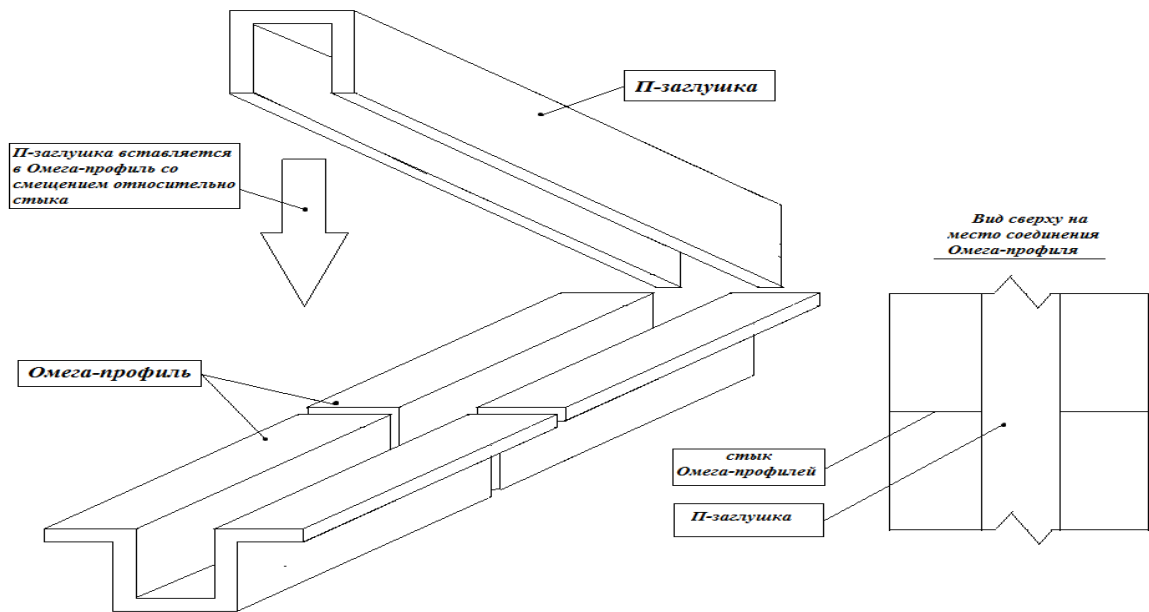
Вид стыковки Омега-профилей в длину, “стык в стык”
